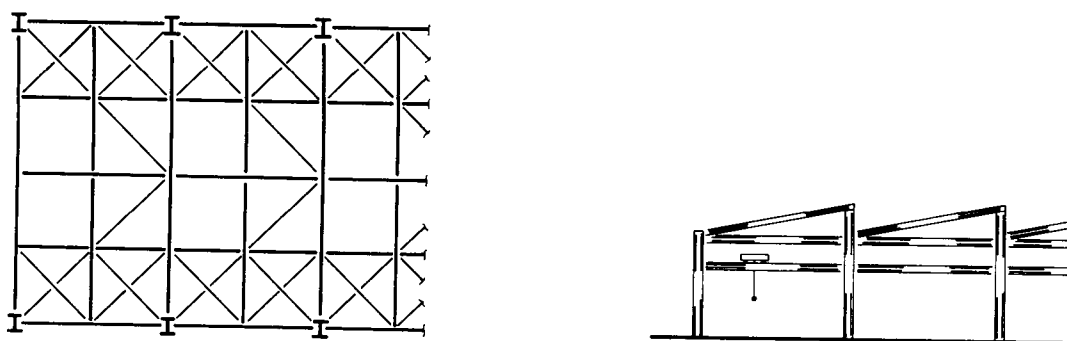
Contraventamentos no plano das terças para sheds em viga de alma cheia
